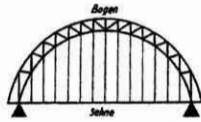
Schema des Konstruktionsprinzips der Säugerwirbelsäule. Nach SLATJER
